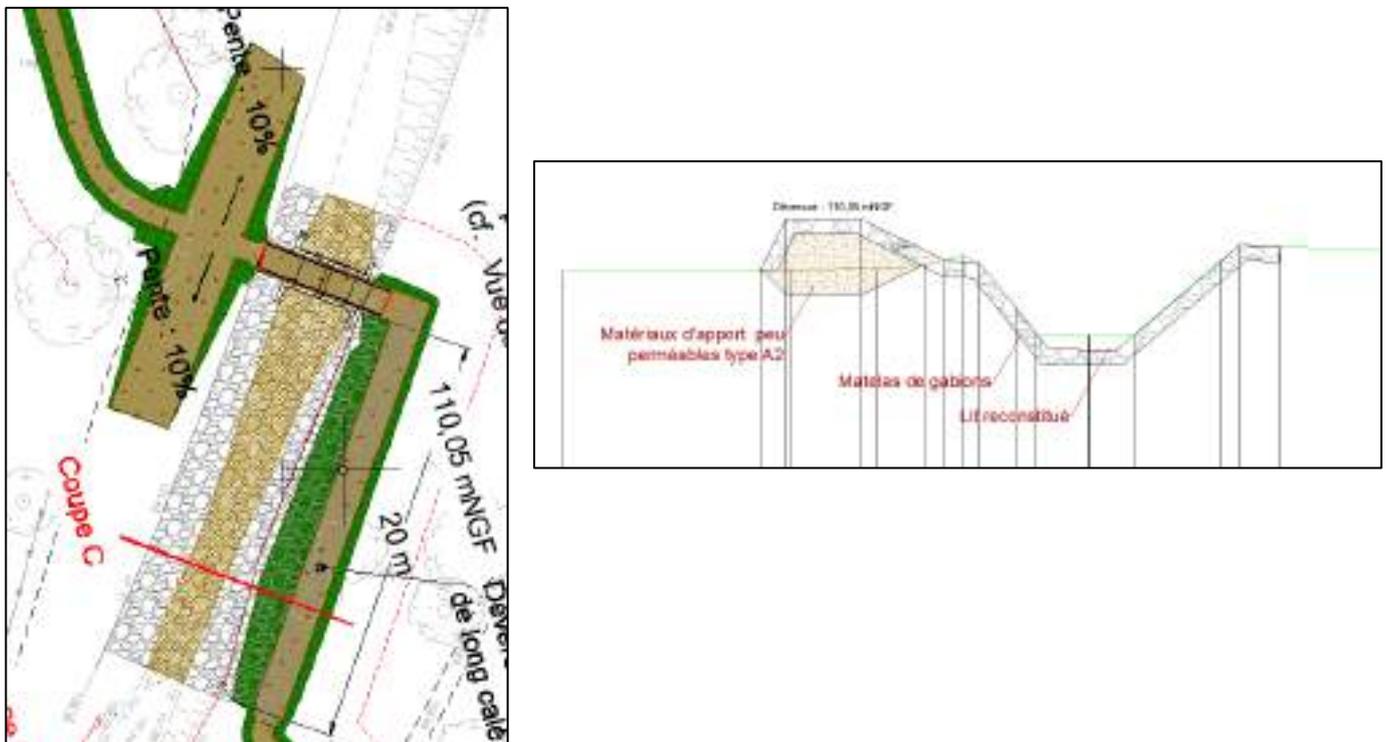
Vue en plan et coupe du déversoir (Source : Antea Group)
